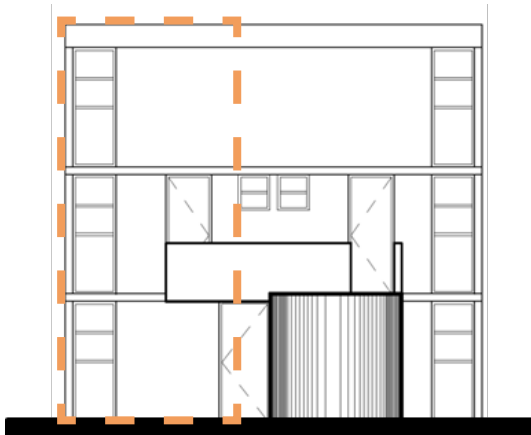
Fachada original donde se indica con línea punteada el área intervenida
